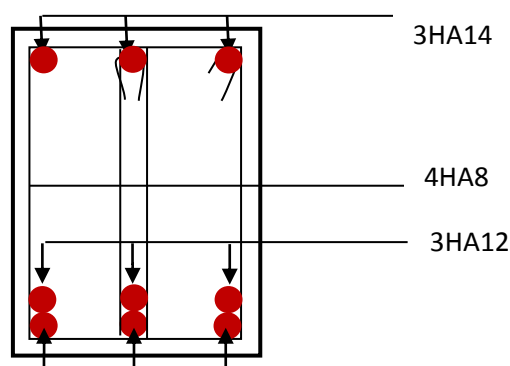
Ferraillage En Travée d'une Poutre Principale.
